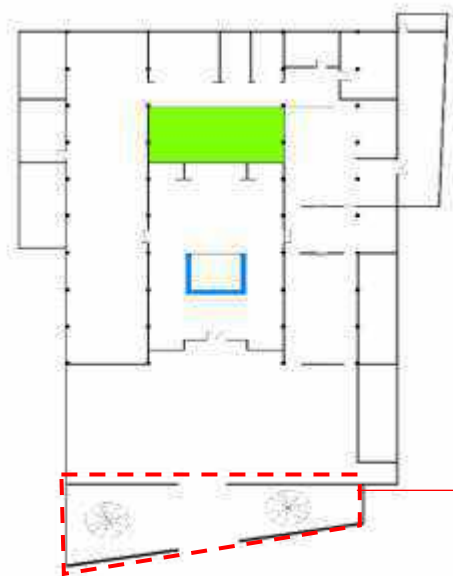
Tatahan Ruang Klenteng Dewi Kwan Im
